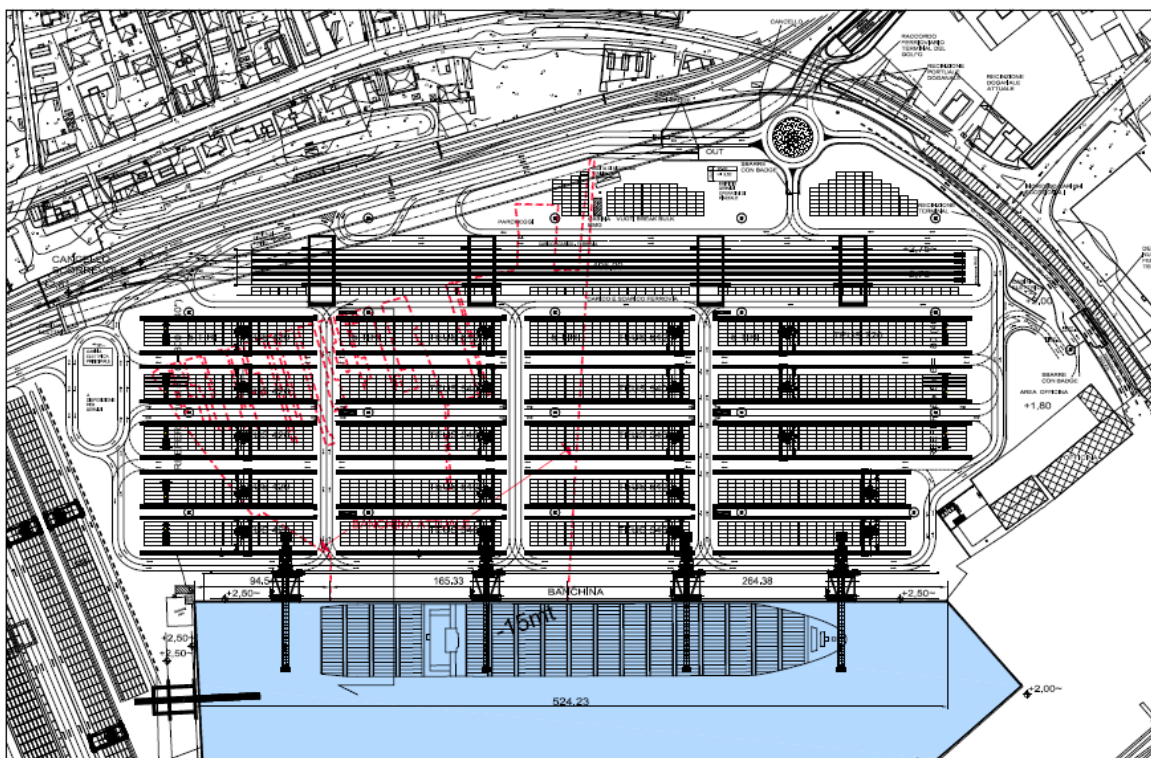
Progetto Preliminare 2015 Nuovo terminal Ravano - Planimetria di progetto -
